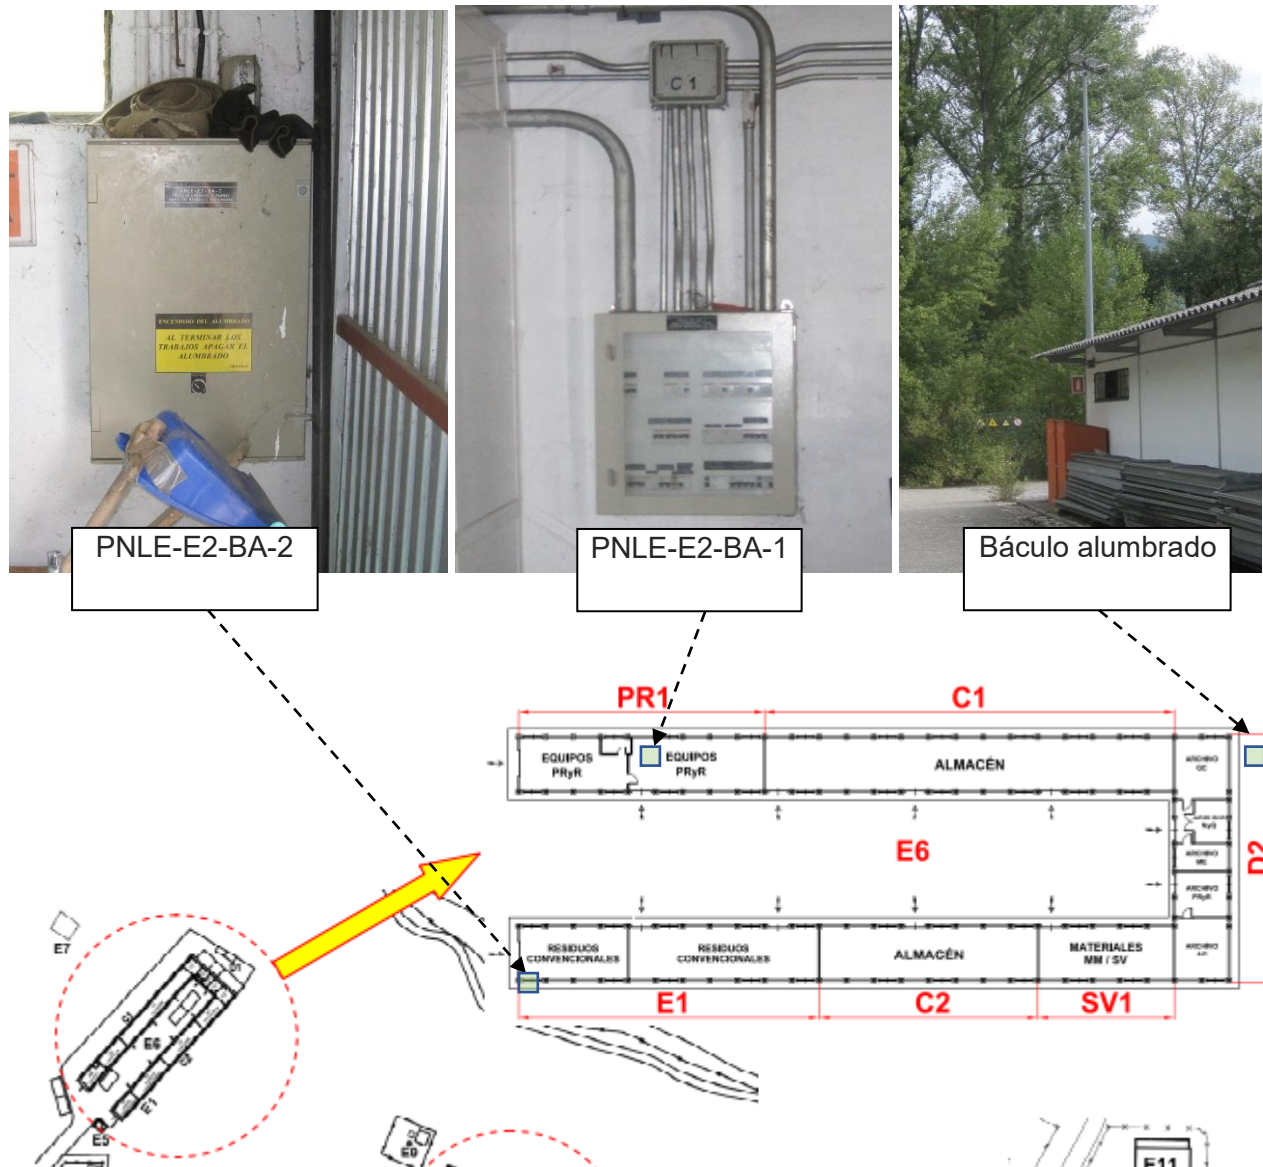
Localización existente paneles PNLE-E2-BA-1/ 2 y báculo alumbrado exterior.
